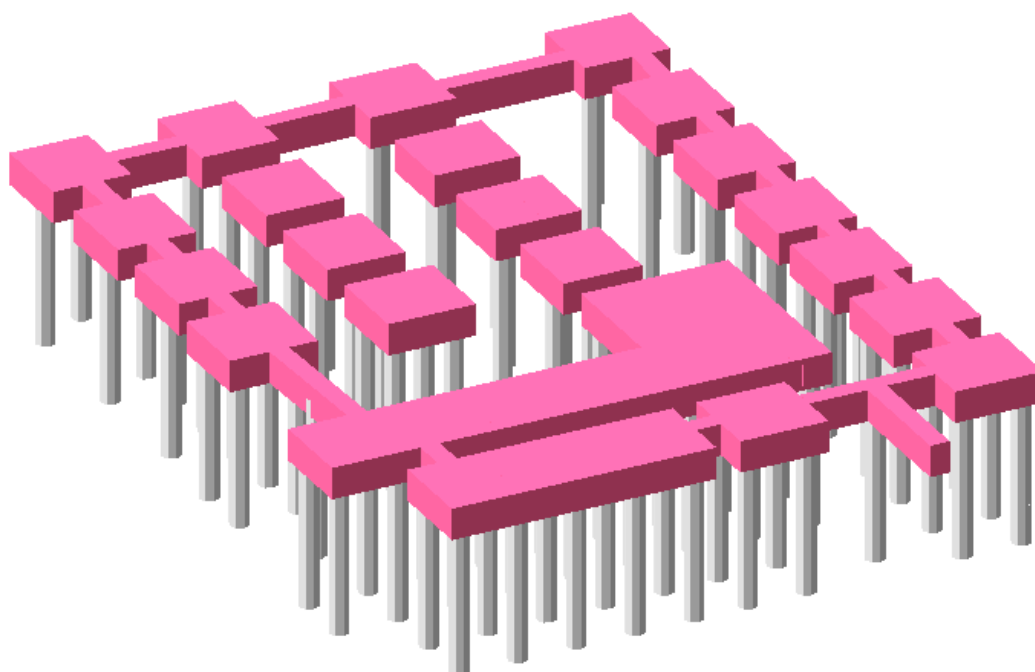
Модель фундаментів (палі і ростверки) половини будівлі
